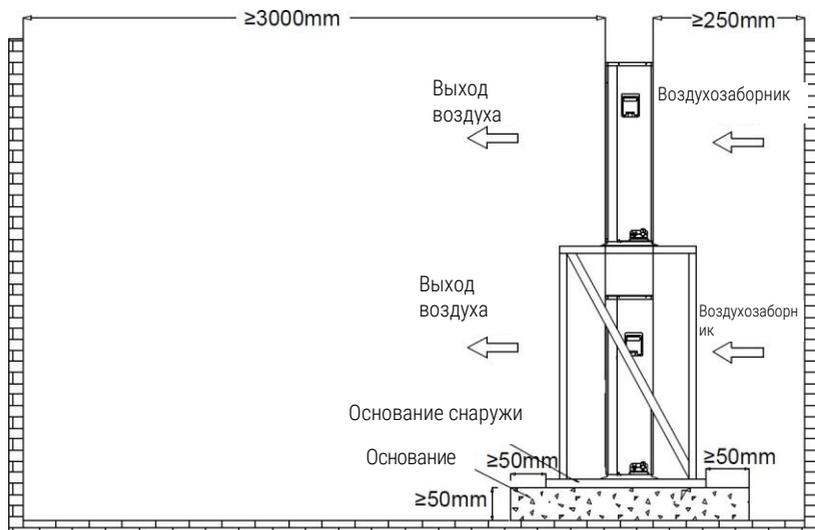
Схематический набросок установки наружного блока внахлест
